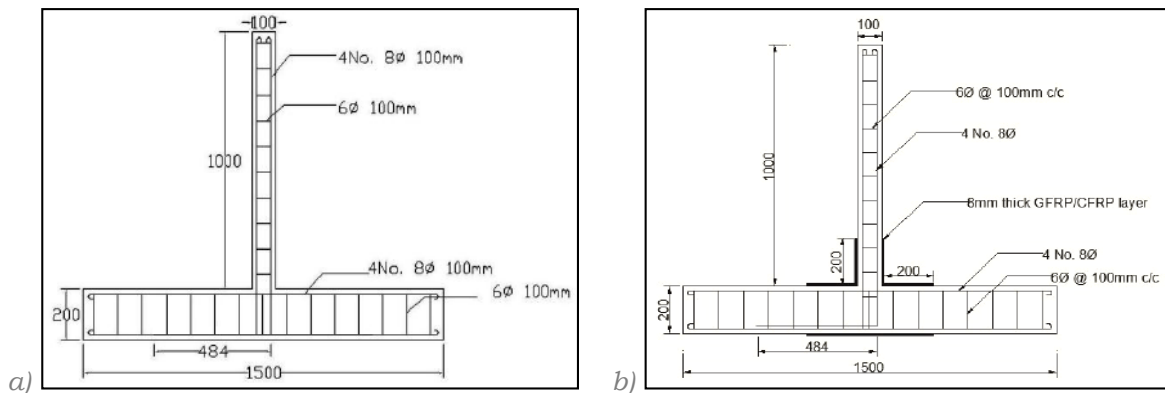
a) Detalles de refuerzo para la columna sin refuerzo. b) Detalles de refuerzo para columnas reforzadas. Todas las dimensiones están en mm. (Jaya y Mathai, 2012)
